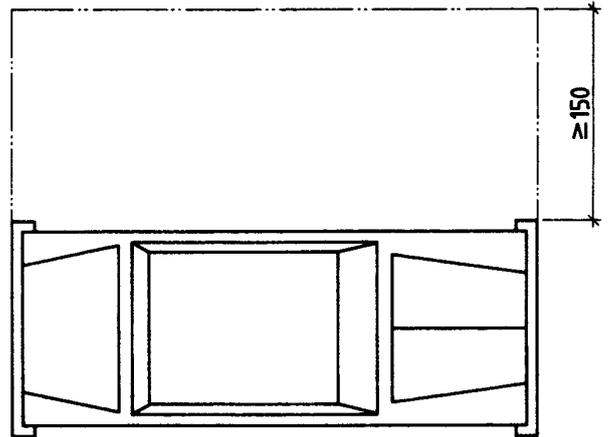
Bewegungsfläche vor einer Längsseite des Kraftfahrzeugs
